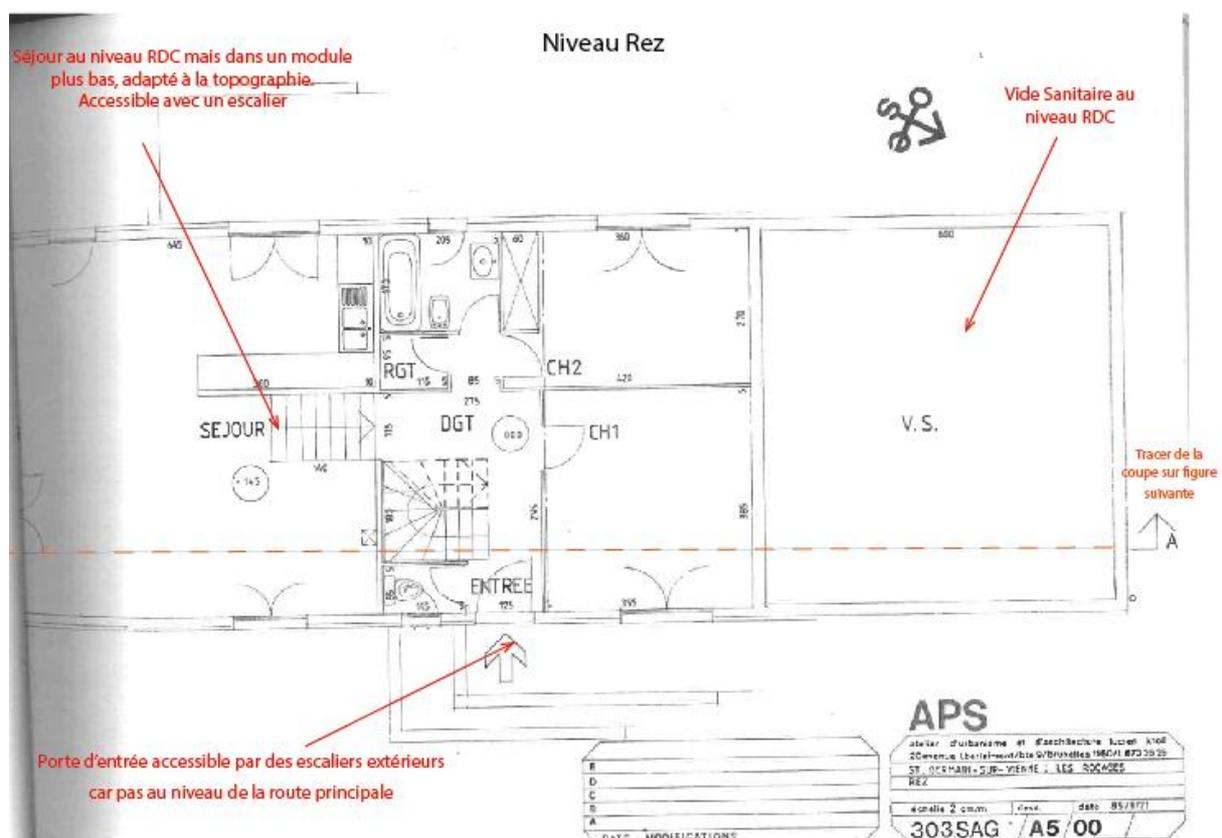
Plan de Lucien Kroll du logement A5, sur le plan d'implantation ci-dessus.
